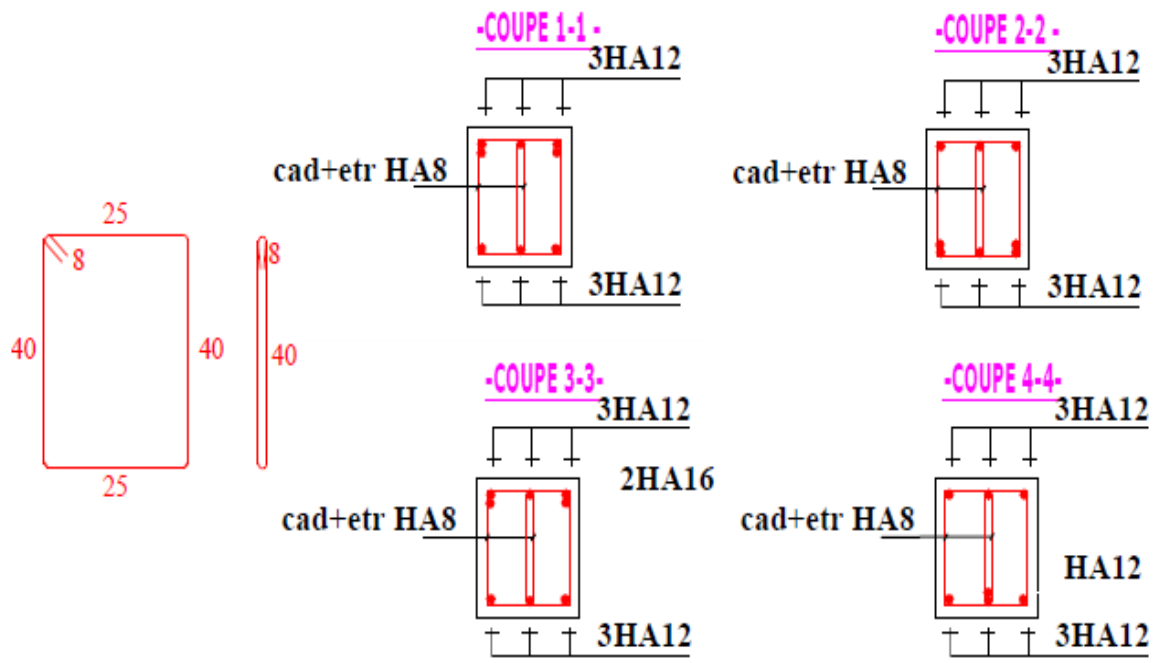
coupes transversales de la poutre principale (30x45)
